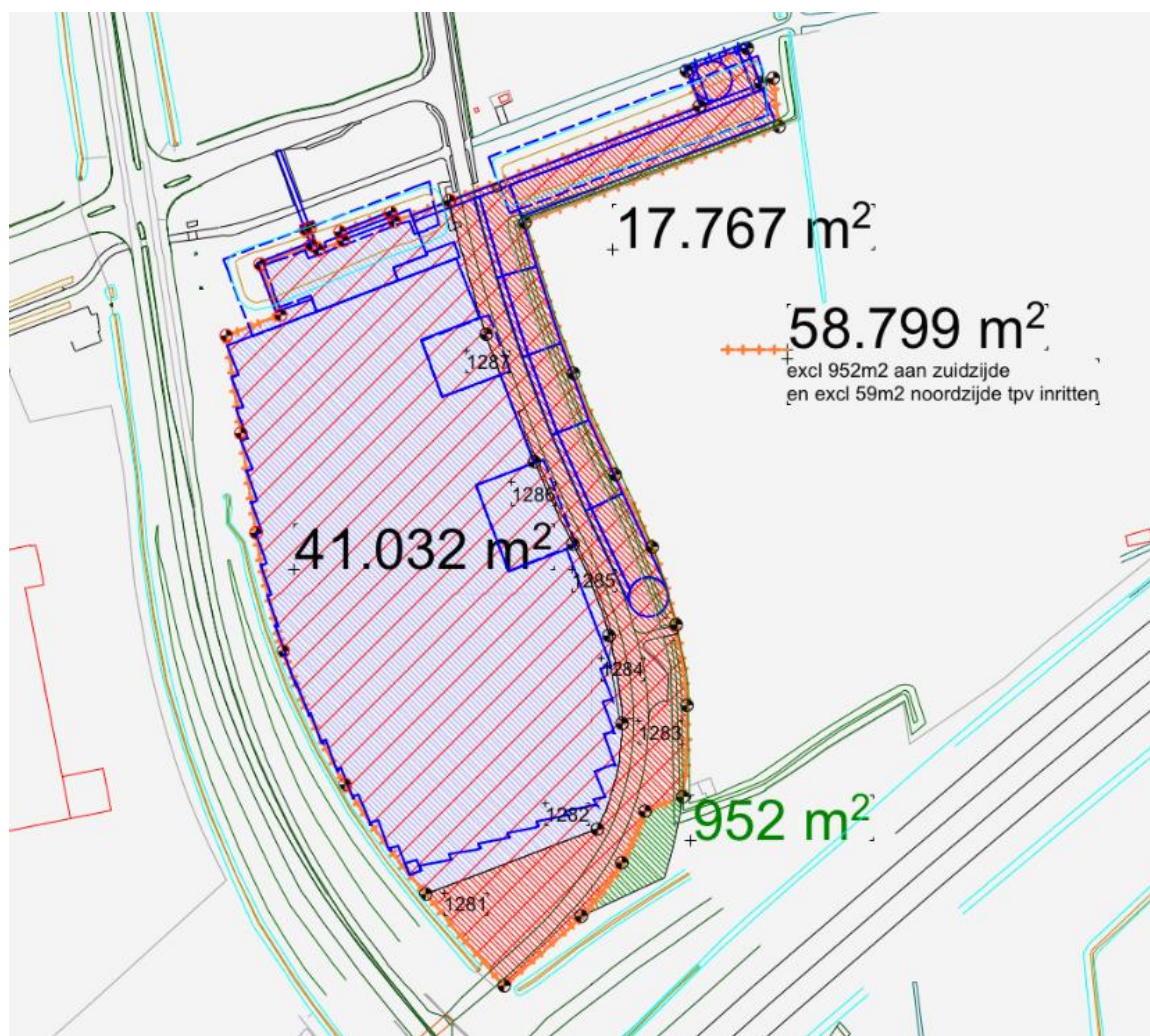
Stedenbouwkundig plan, verkaveling Woonbos west
